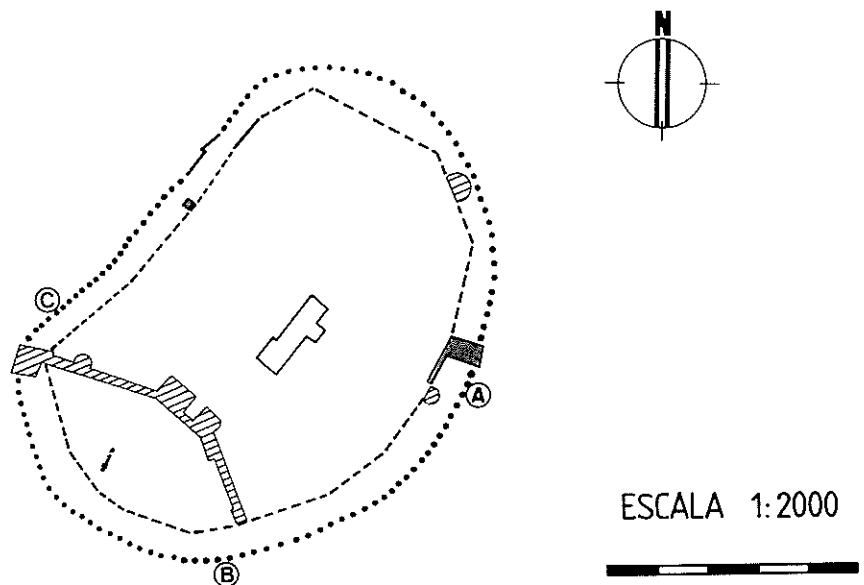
Castelo de Moura - planta esquemática das muralhas
